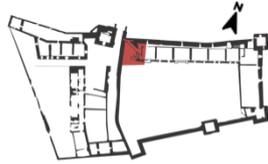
Projeto de Scarpa para Espaço Cangrande; planta baixa
